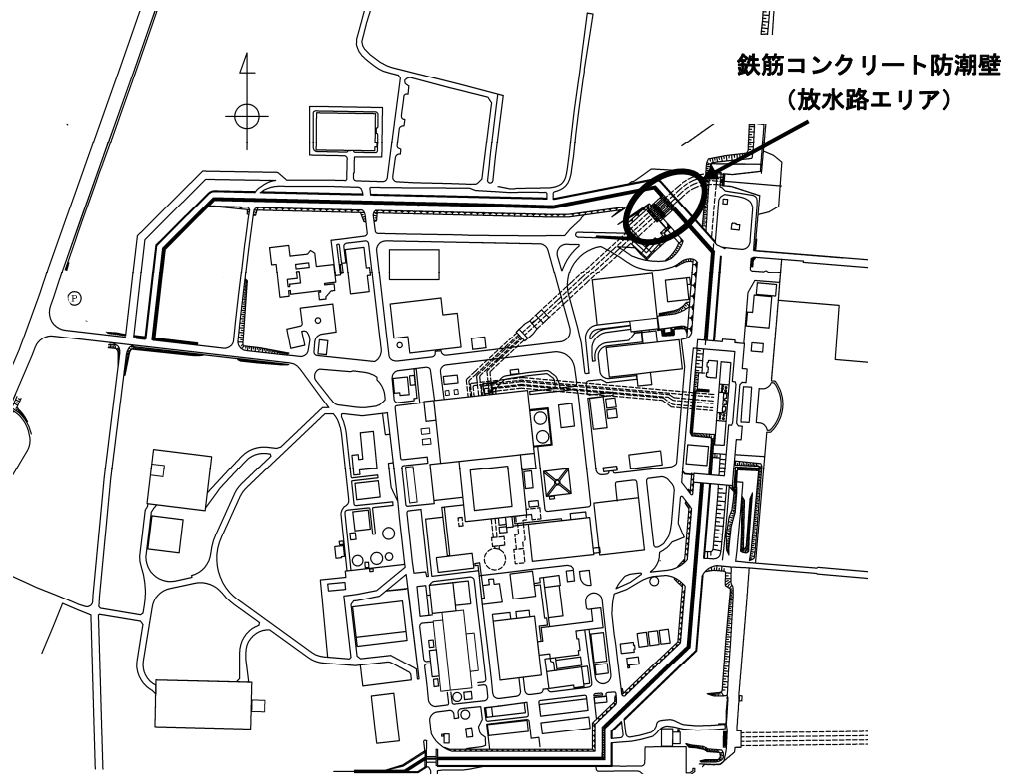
鉄筋コンクリート防潮壁（放水路エリア）の位置図
